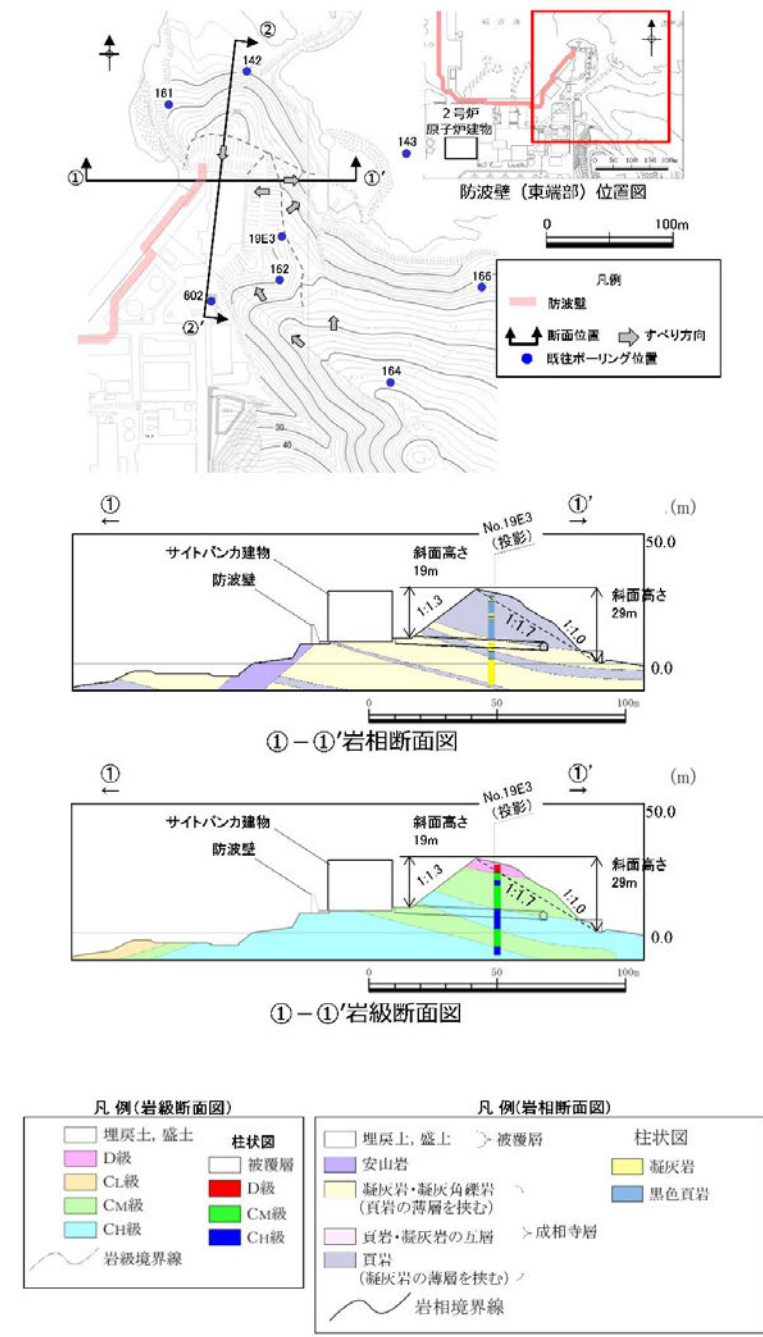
(1) 防波壁(東端部) 地質断面図・岩級断面図
